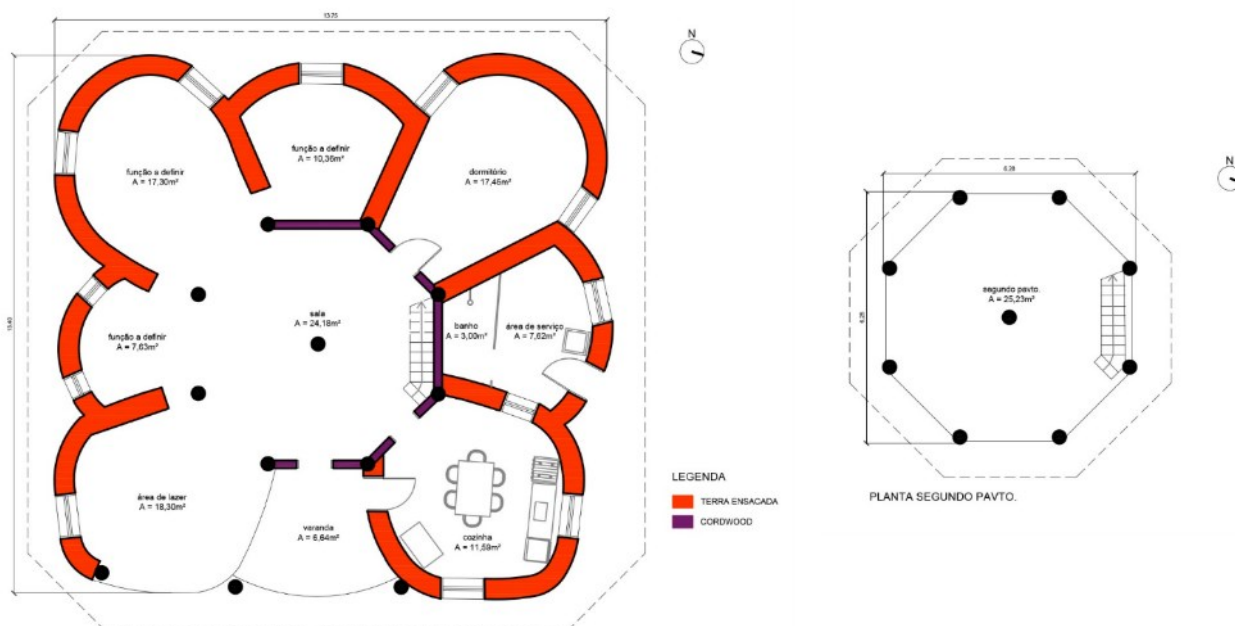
Plantas baixas do térreo e do segundo pavimento da Edificação 03.
